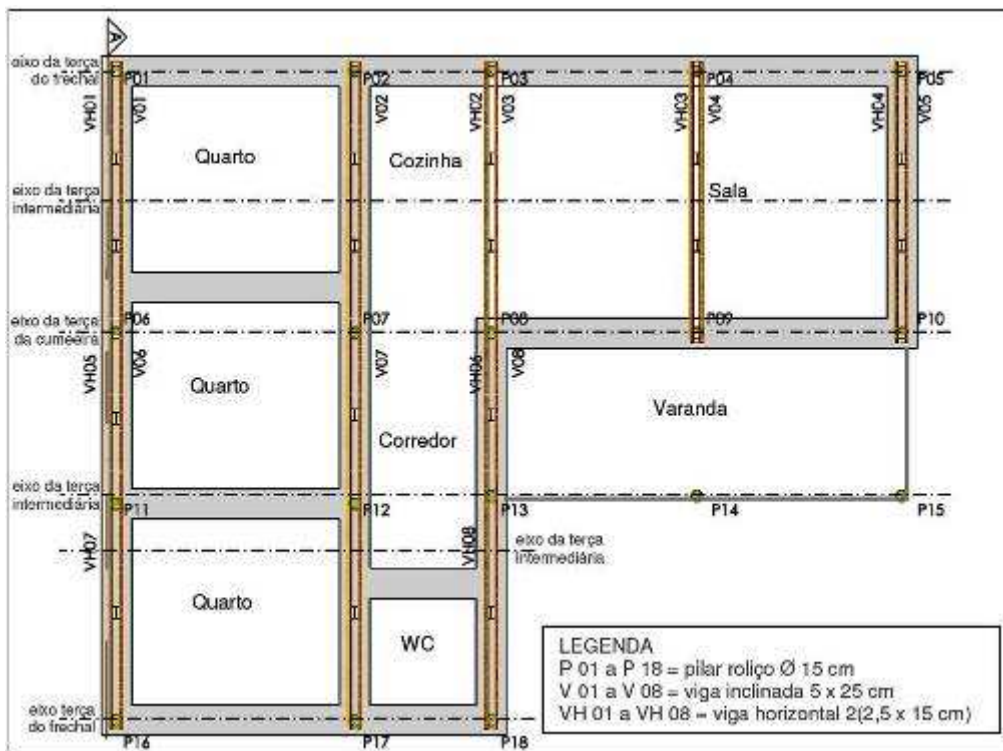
Planta da casa no sistema estrutural pilar-viga e vedação com adobes (acervo HABIS).
